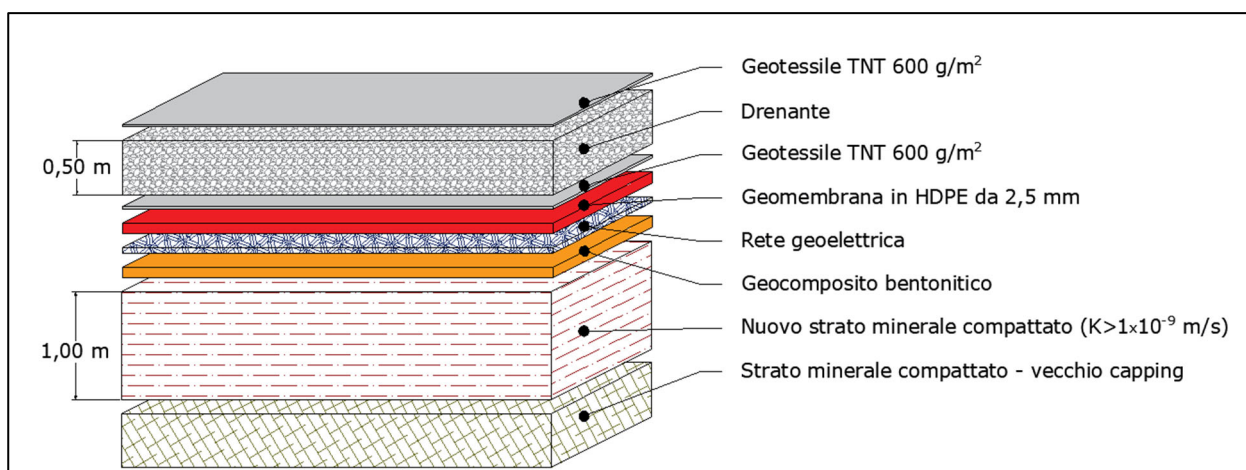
/XII: Pacchetto impermeabilizzazione con sistema drenante - Caso b)
